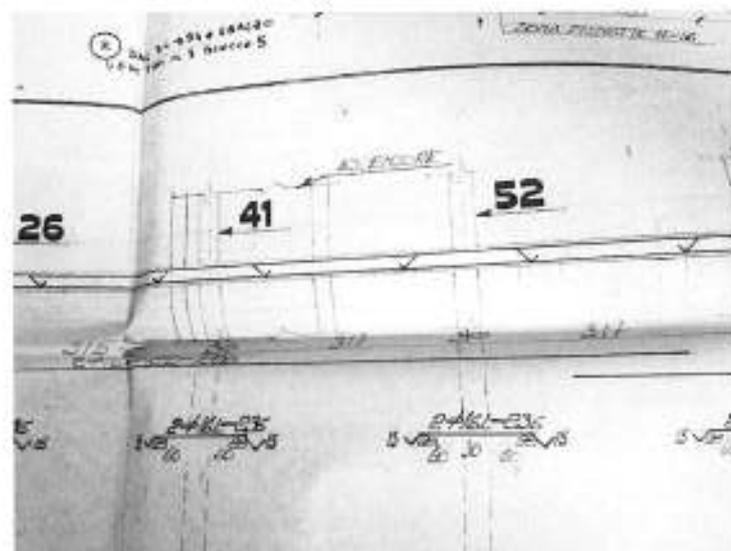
TAV. 2 – prospetto armatura trave T6 (particolare intorno al vano ascensore)
